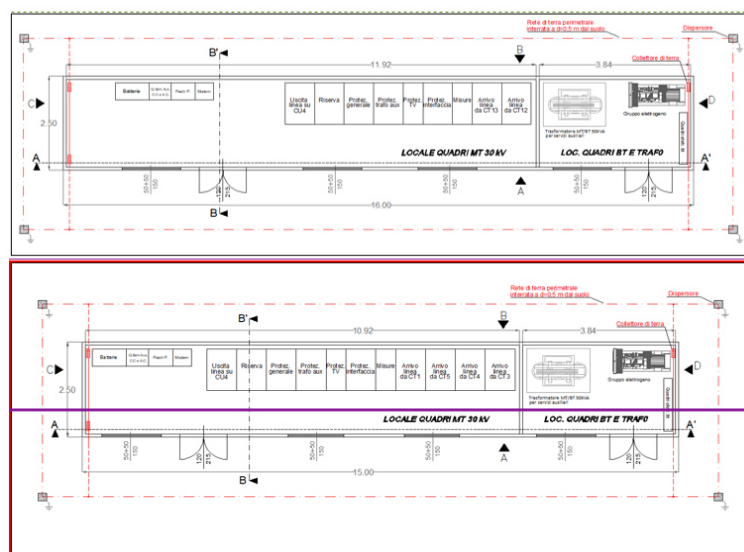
Pianta della cabina utente con i dispositivi di protezione in MT
